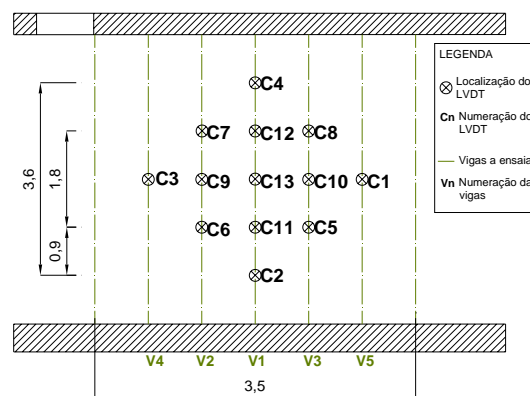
Planta da faixa ensaiada com a localização dos LVDTs.
